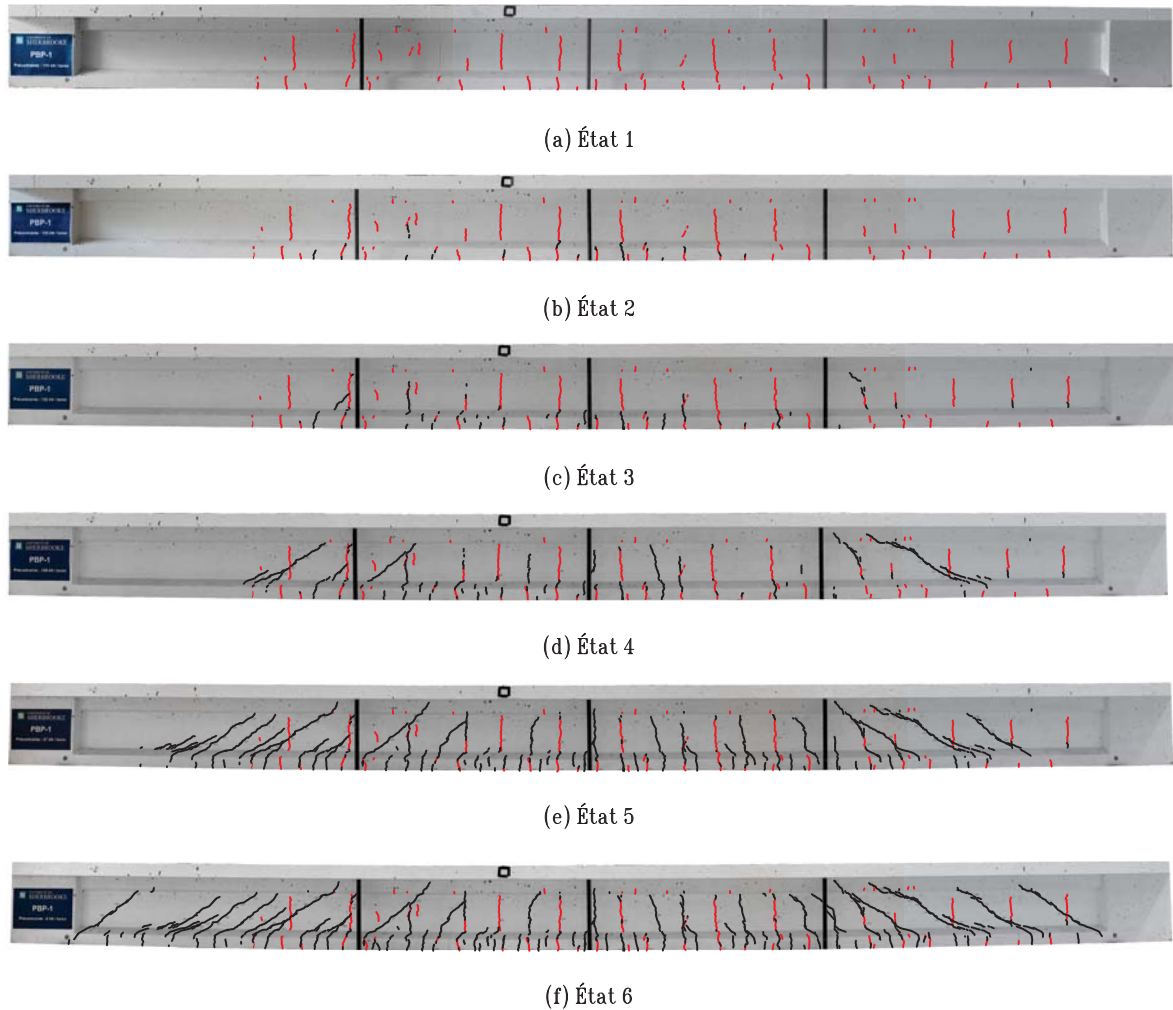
Évolution de la fissuration de la poutre PBP-1 avec chargement lors du relâchement de la précontrainte
